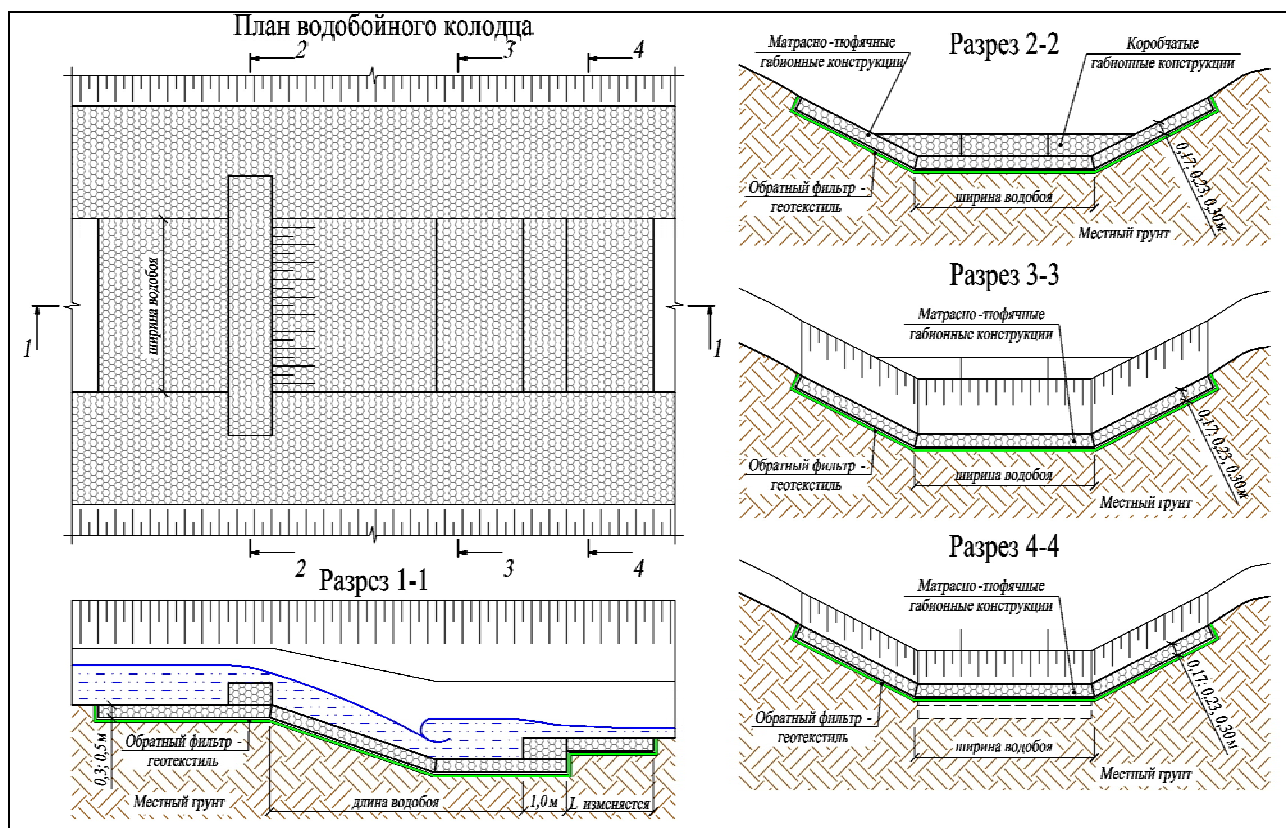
Водобойное устройство из габрионных конструкций (вариант 6)
